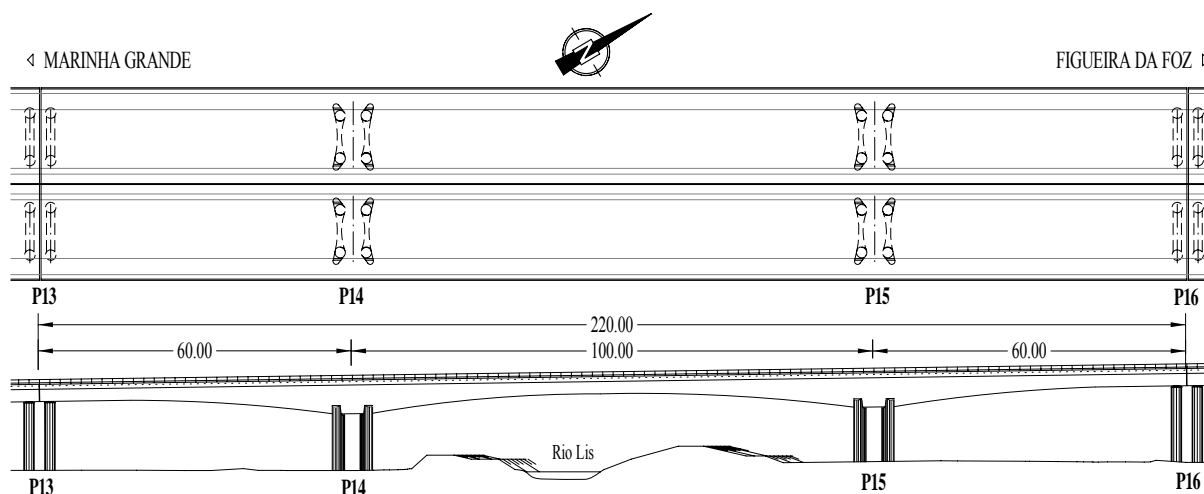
Planta e alçado da Ponte sobre o Rio Lis.
